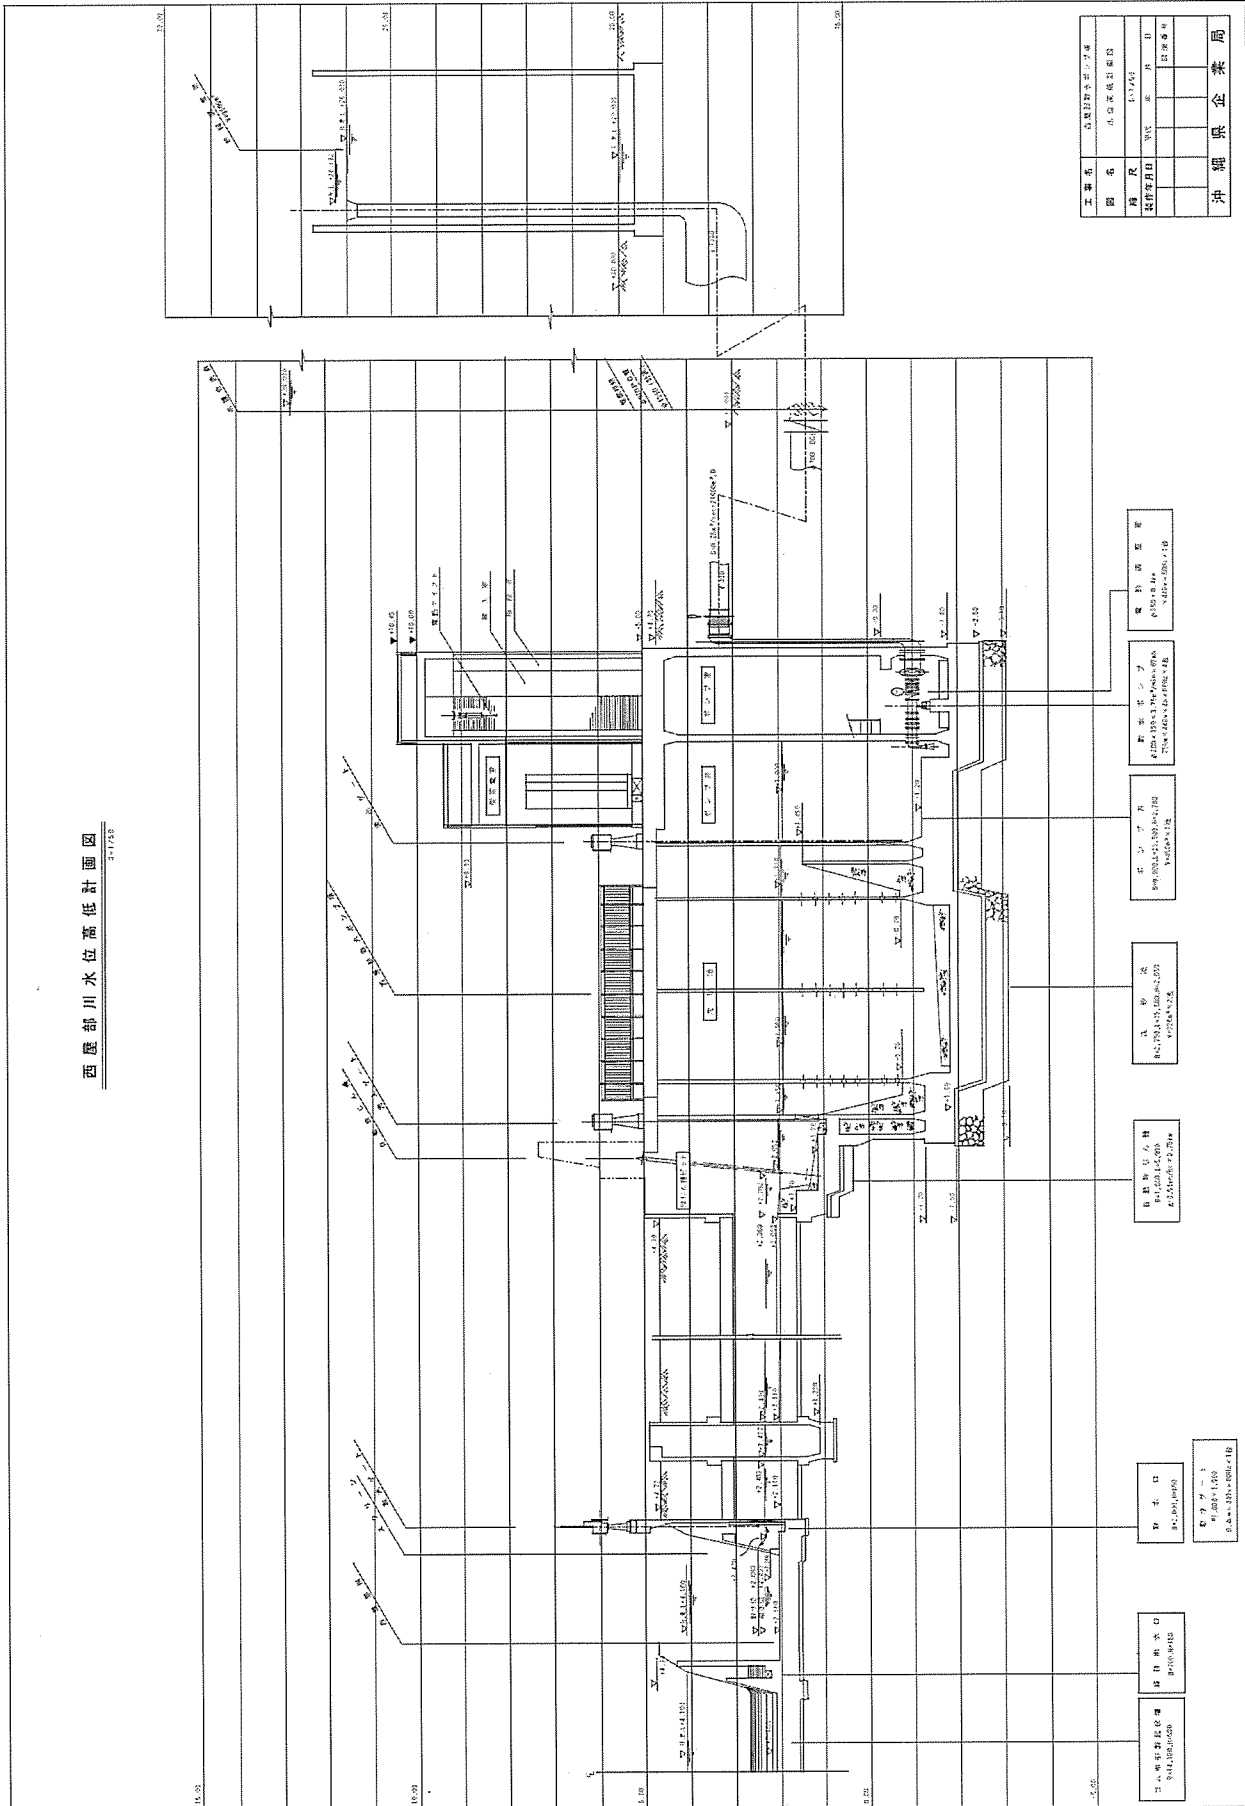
西屋部取水ポンプ場 水位高低計画図
